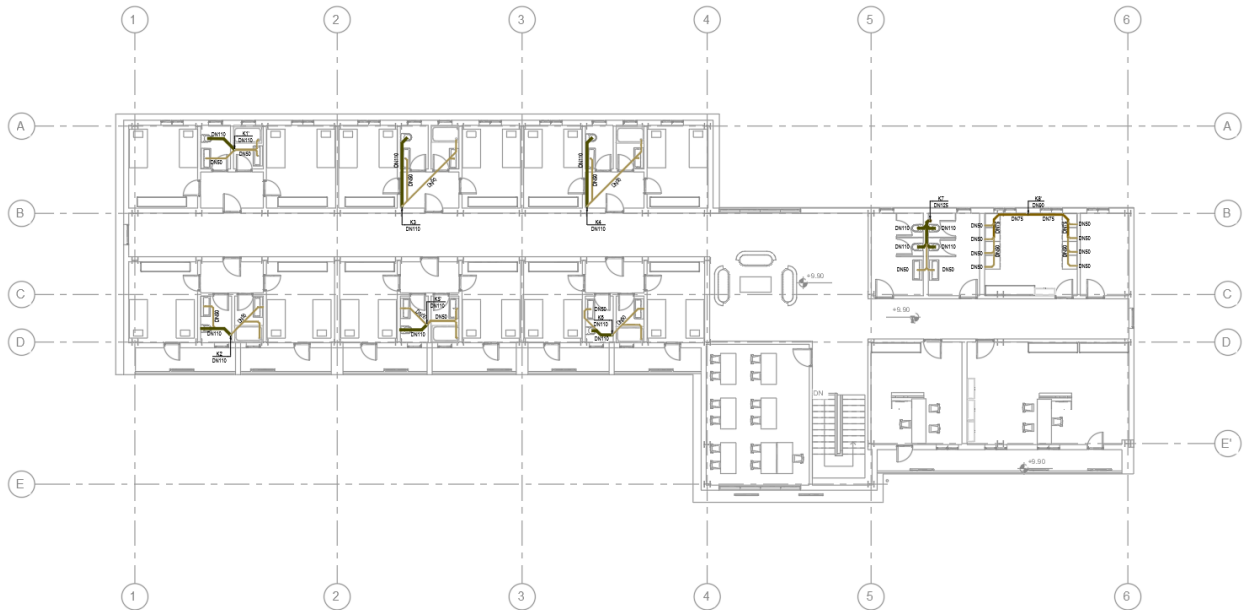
Planimetria e Shkarkimit të Ujërave të Ndotura në dhomat e akomodimit
